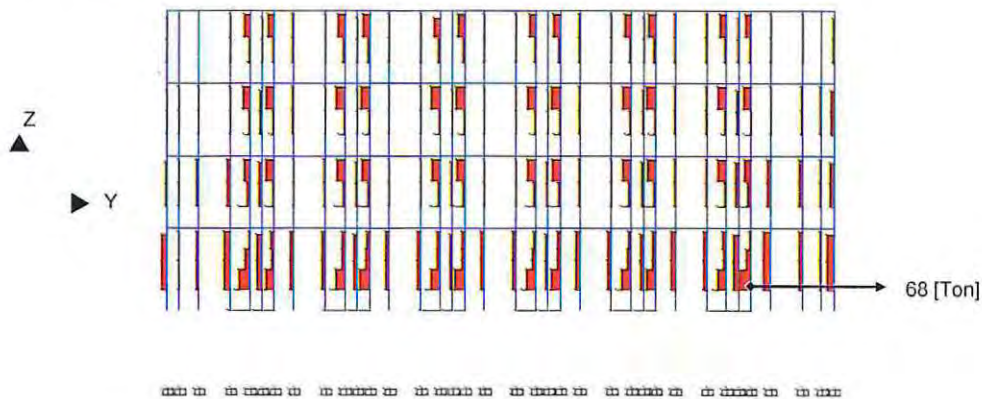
Diagrama carga axial en columnas de fachada, eje A.
